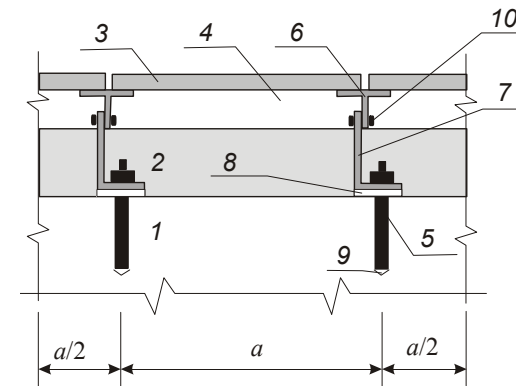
Исследуемая конструкция вентилируемого фасада с вертикальным расположением направляющих:
